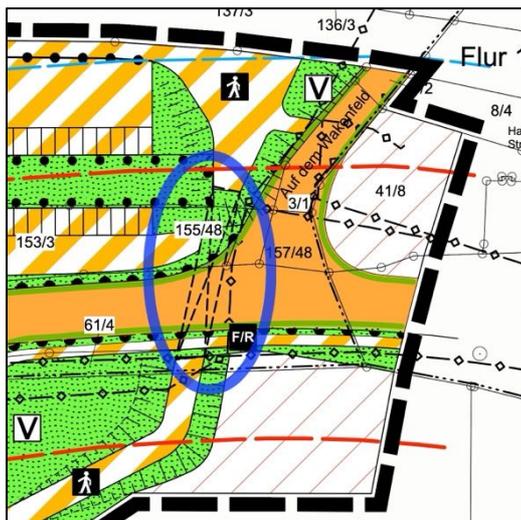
Fußgängertunnel - Ausschnitt Bebauungsplanentwurf
